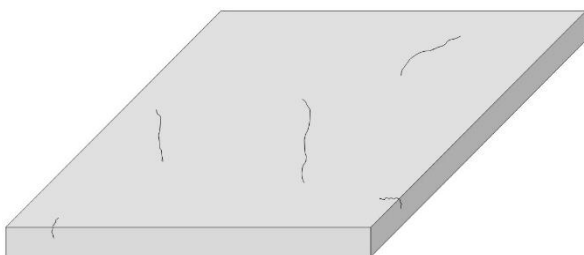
Fisuras por tensiones de origen térmico.
